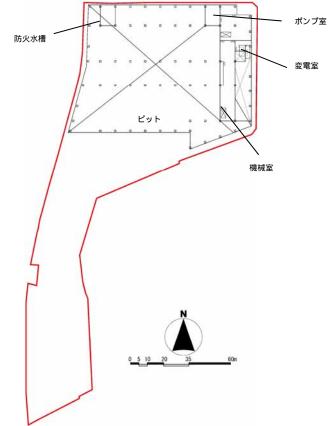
(1) 各階平面図(地下2F)(変更前:評価書)
